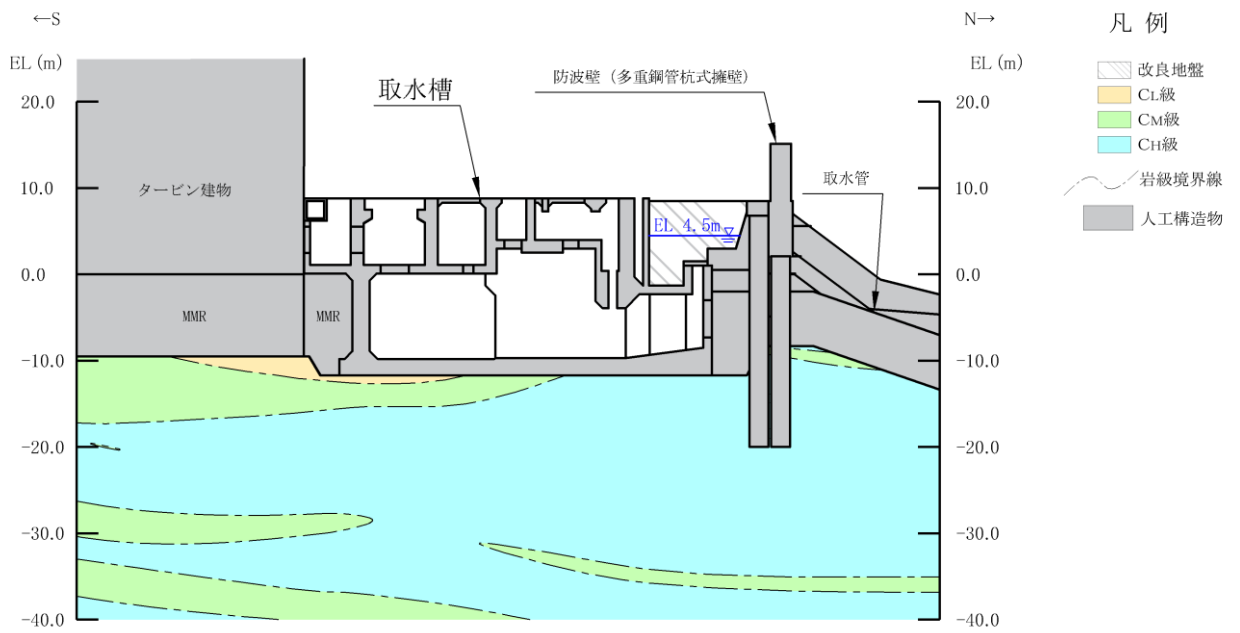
取水槽 地震時荷重算出用地質断面図 (D-D断面)
